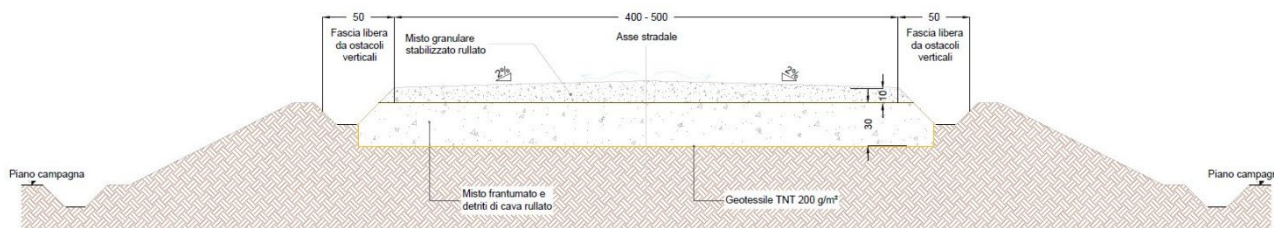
Sezione tipo pista di impianto su rilevato; misure in centimetri
